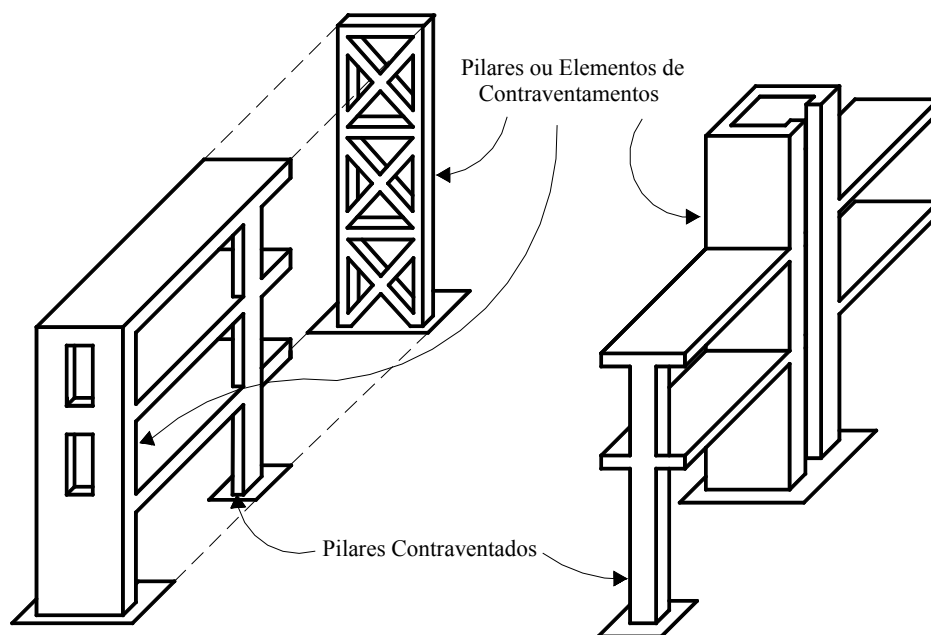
Pilares contraventados e elementos de contraventamento (FUSCO, 1981).
